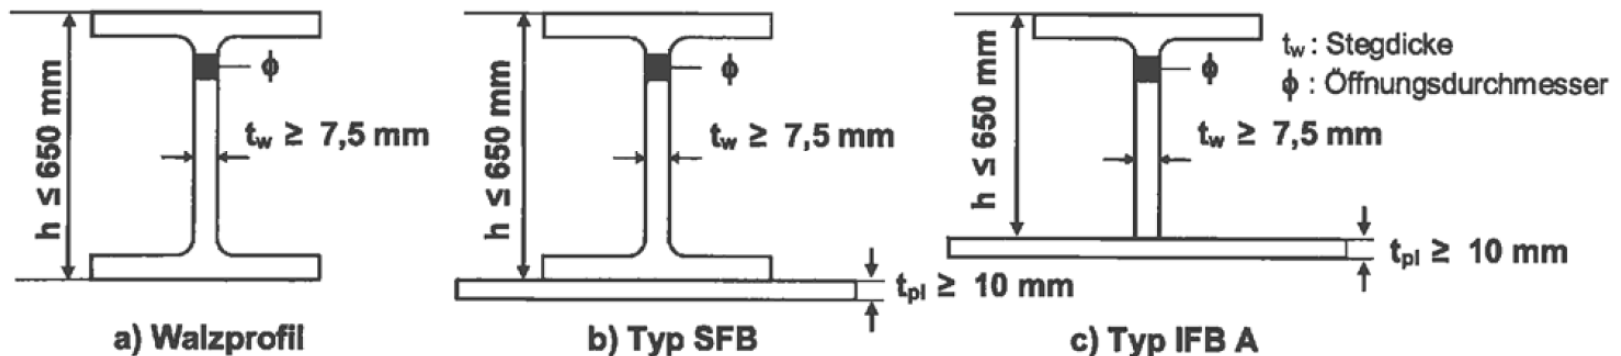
Zulässige Querschnittsformen der Stahlträger
